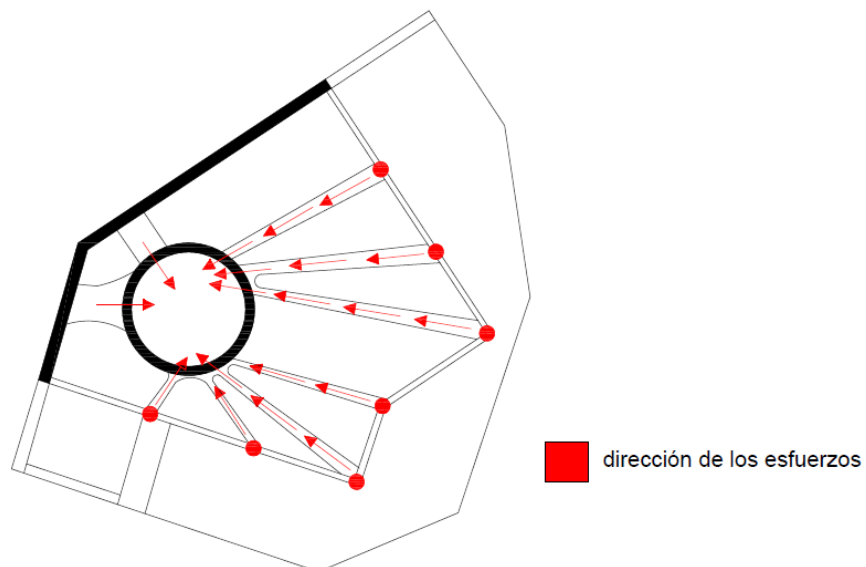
esquema del recorrido de las cargas en la azotea a través de las vigas ménsula
